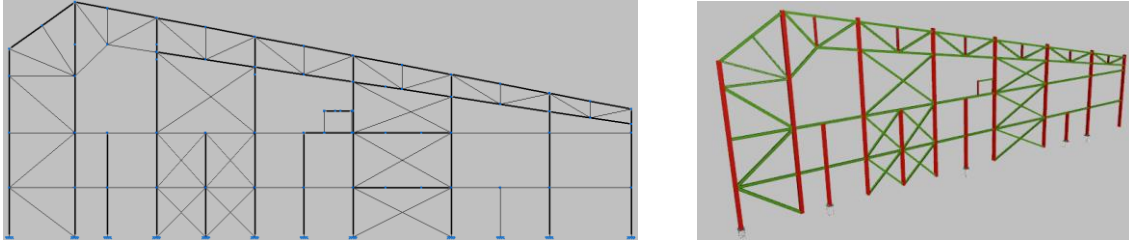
CYPE 3D – Pórtico de fachada este.
